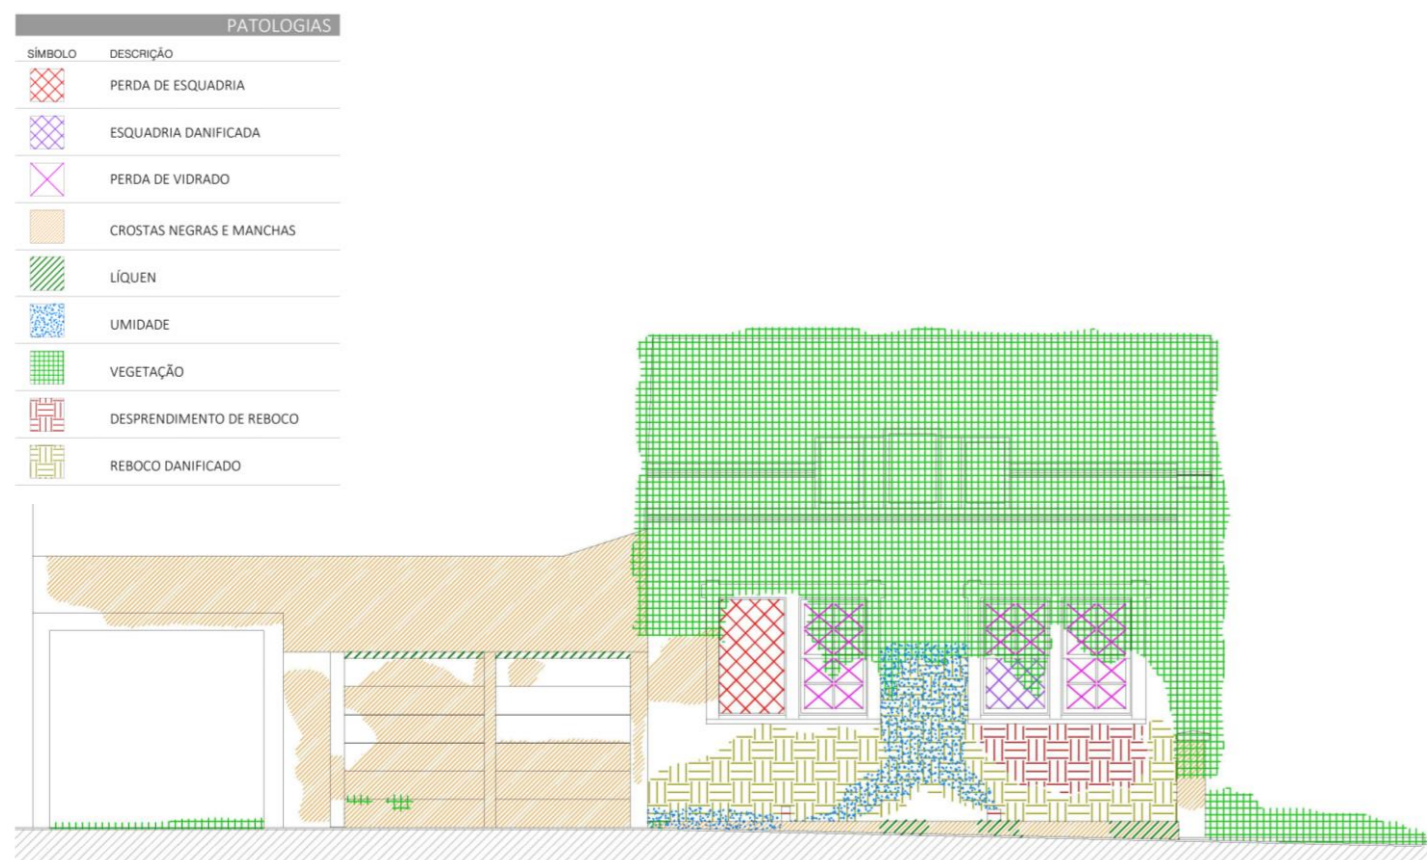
Mapeamento de danos – Fachada Rua Fernando Machado.
